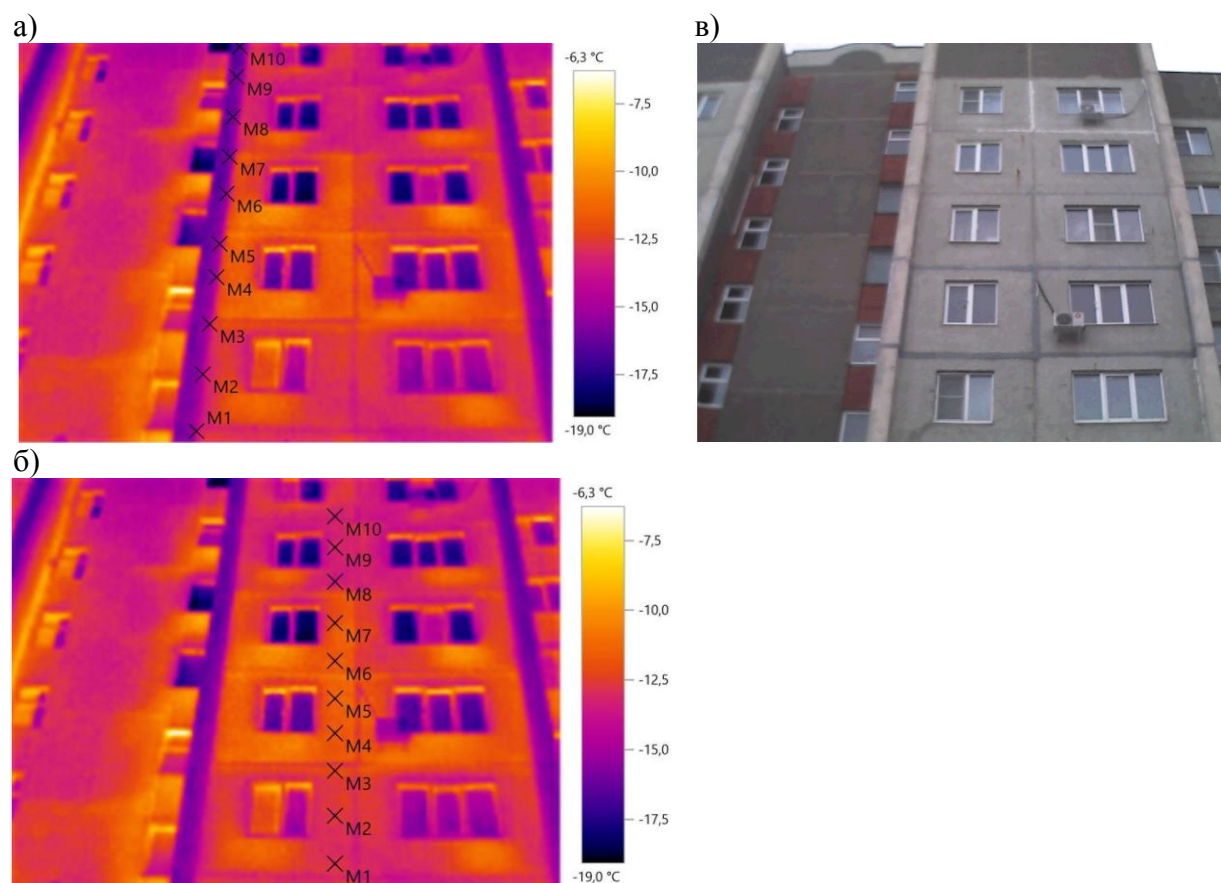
Натурные исследования северного фасада здания, подъезд 4:
